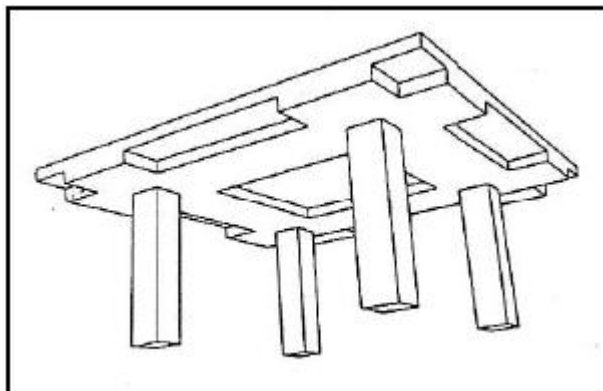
h. Diseño de losa de vigas planas en dos direcciones. [A3]
